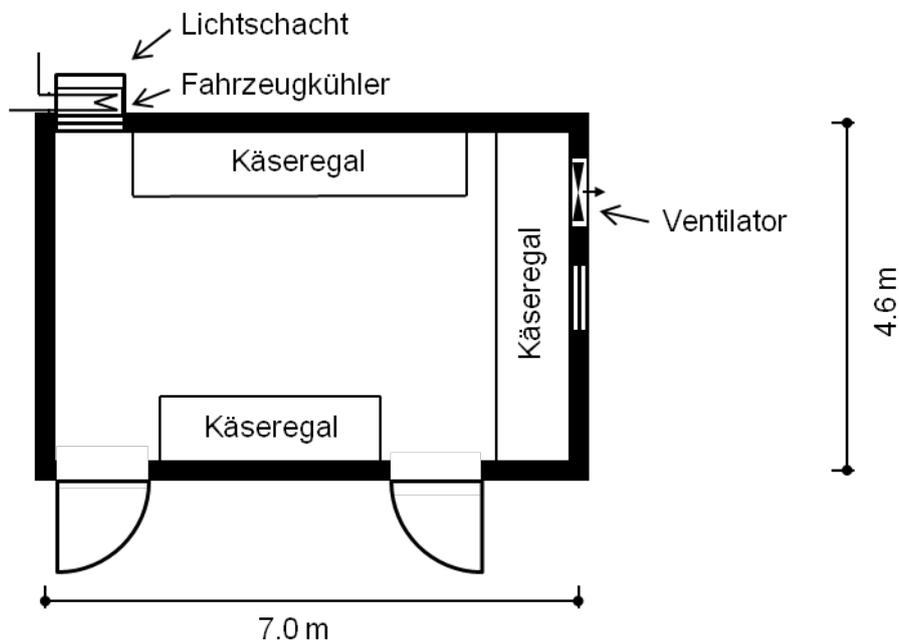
Skizze des Grundrisses eines Käsekellers mit Kühlung über einen Fahrzeugkühler.
